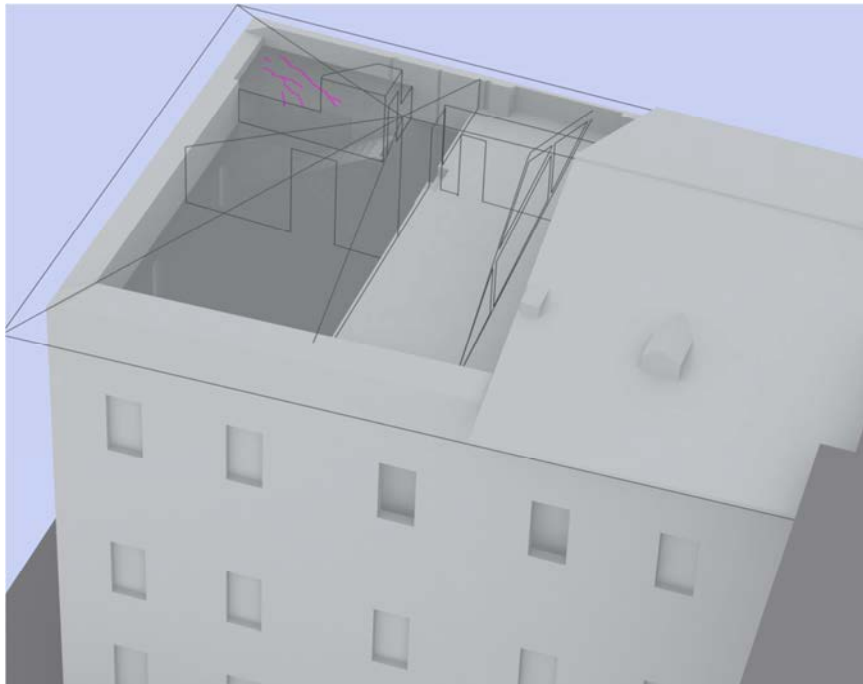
Individuazione nel modello tridimensionale di alcune fessure al piano secondo, parete S-S.
